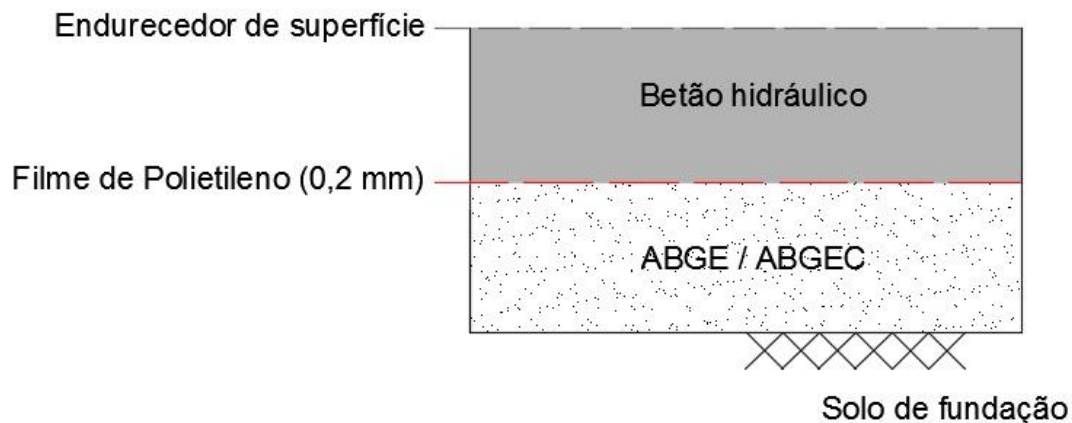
Exemplo da constituição de um pavimento rígido
